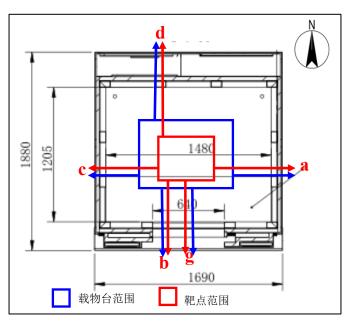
本项目探伤铅房平面布局与预测点位图(单位: mm)
